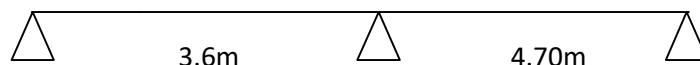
Schéma statique de la poutrelle à 2 travées.
